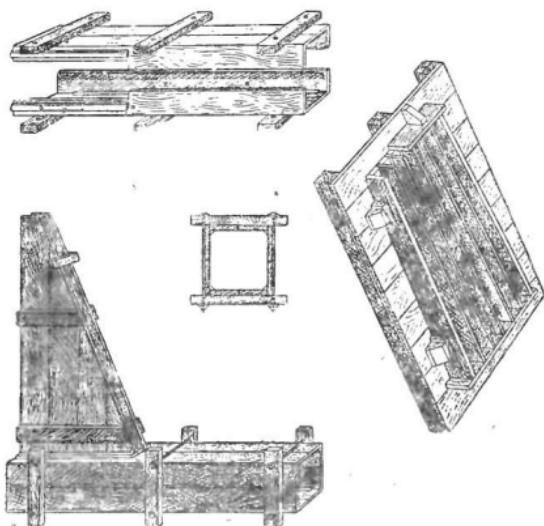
Деревянные формы для изготовления железобетонных подпор.
